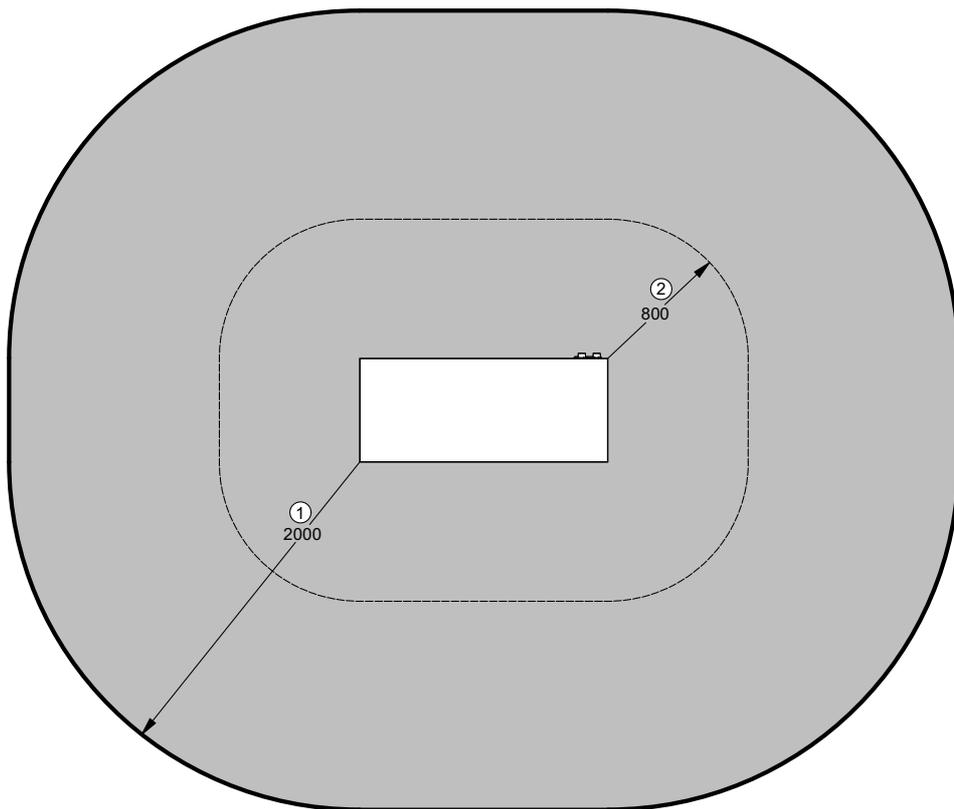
Zona sicura (installazione a livello del pavimento) in caso di installazione libera
